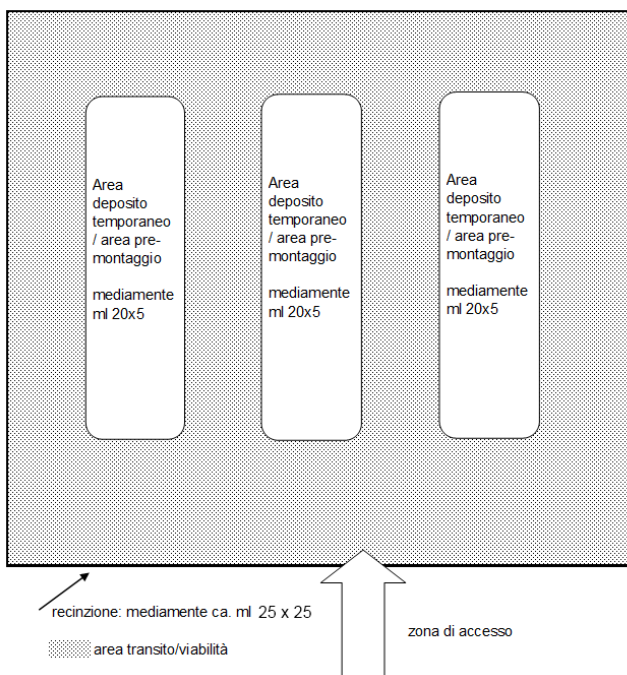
Planimetria dell'Area Sostegno (scavo di fondazione - getto e basi) - Tipologico
